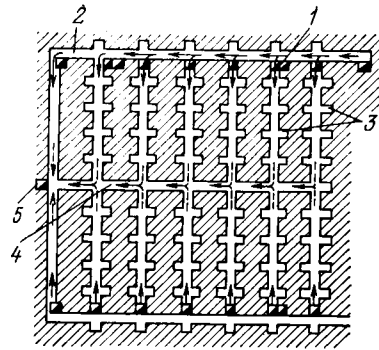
Схема вентиляции выработок на горизонте скреперования:
